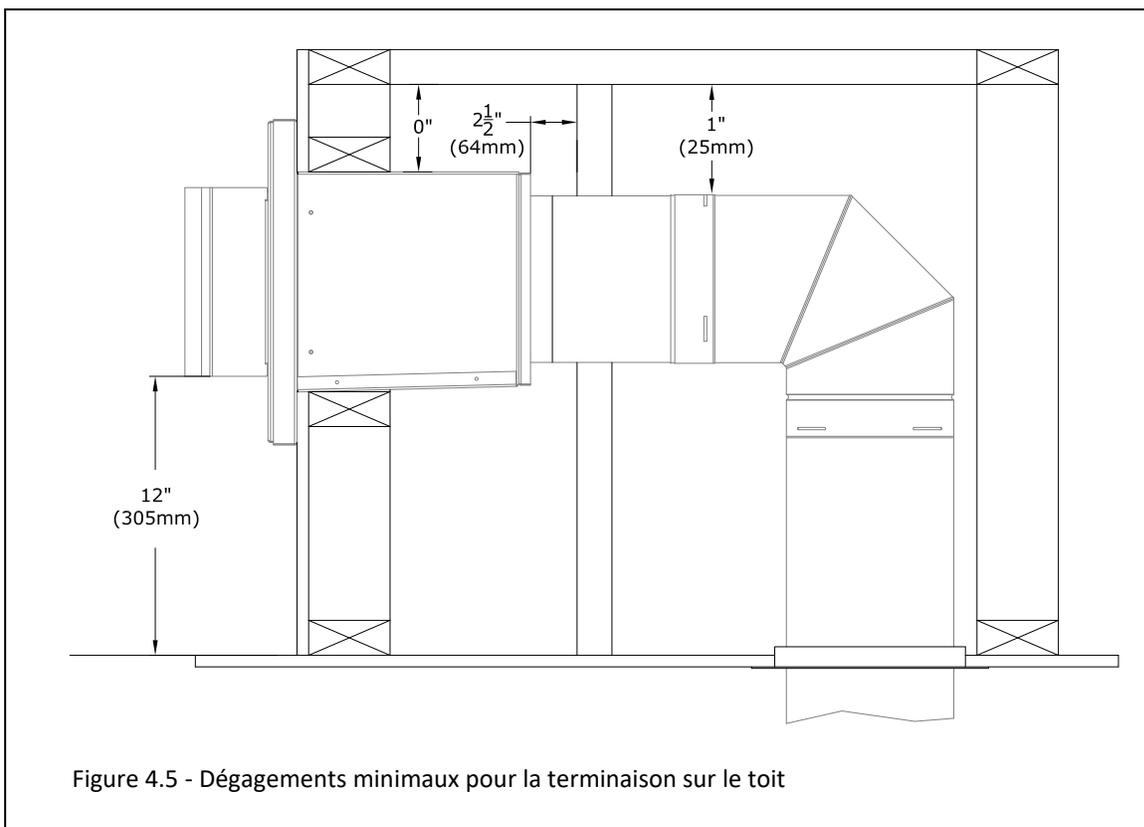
Dégagements minimaux pour la terminaison sur le toit
